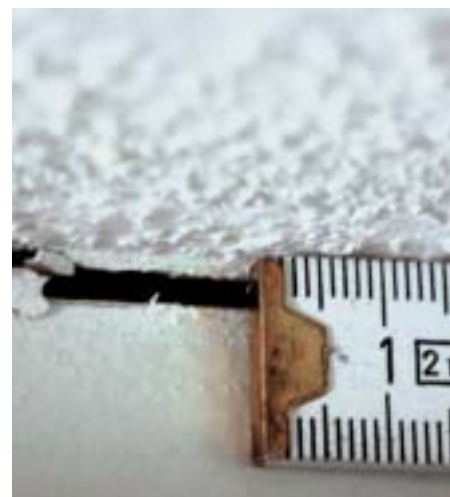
Das Bild zeigt den Anschluss des Deckenputzes an ein Einbaumöbel. Selbst nach mehr als 30 Jahren wird der Spalt im Winter grösser und schliesst sich im Sommer wieder
